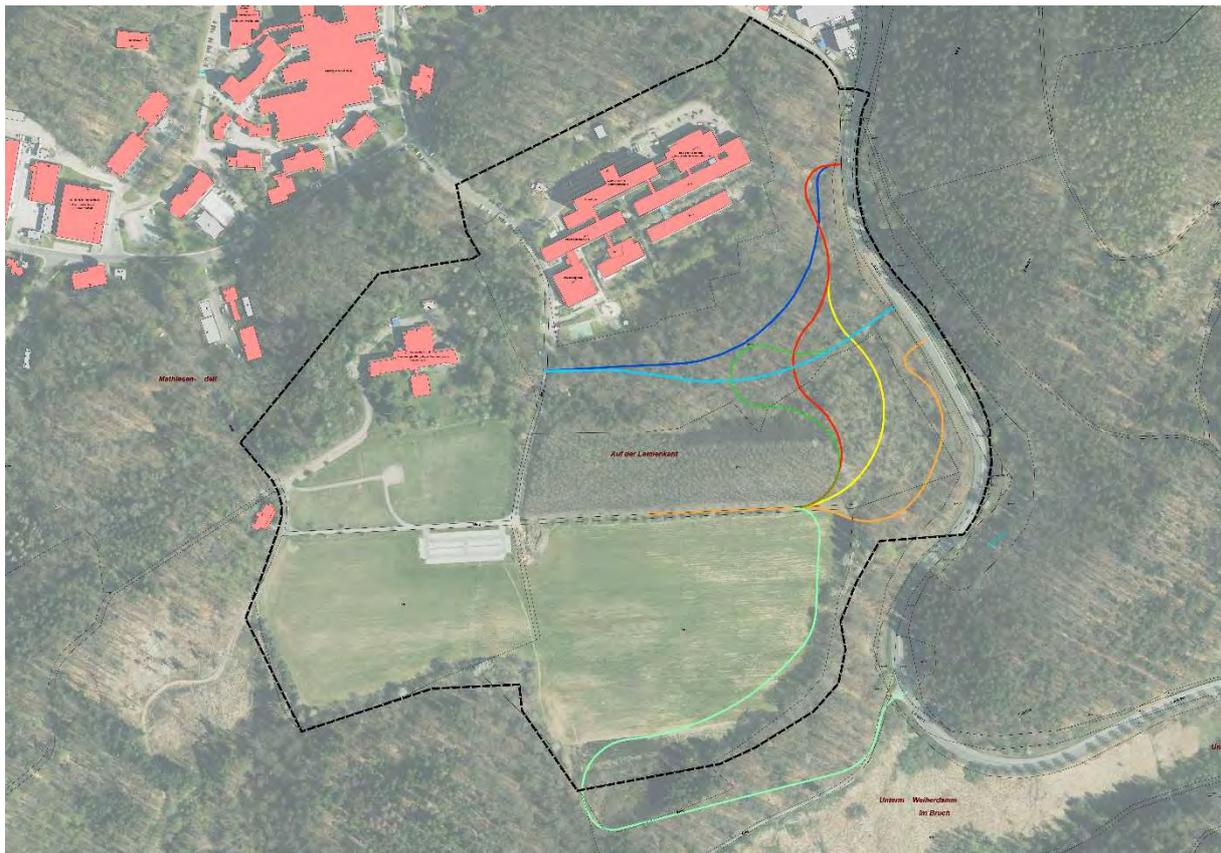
Untersuchte Zufahrtstrassen, Quelle: Kernplan
